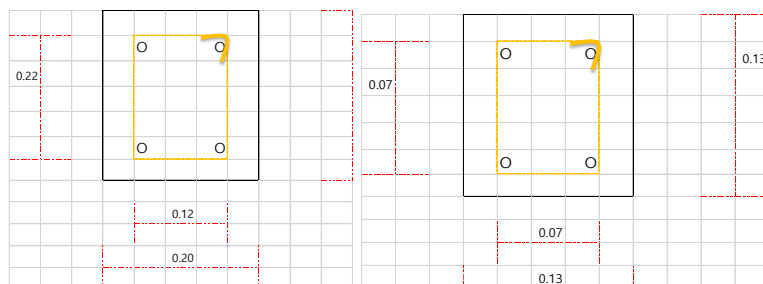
Denah Kolom dan Pondasi Tagana dan Aula
